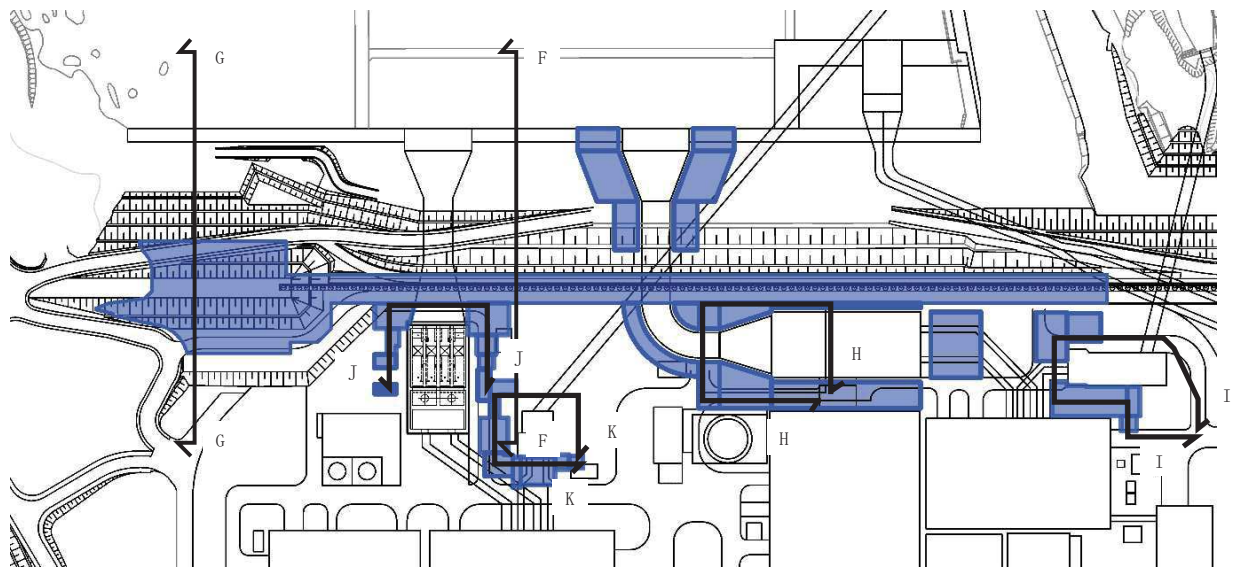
地盤改良体の平面配置図 (防潮堤, 防潮壁, 防潮堤 (第 3 号機取水路横断面))
